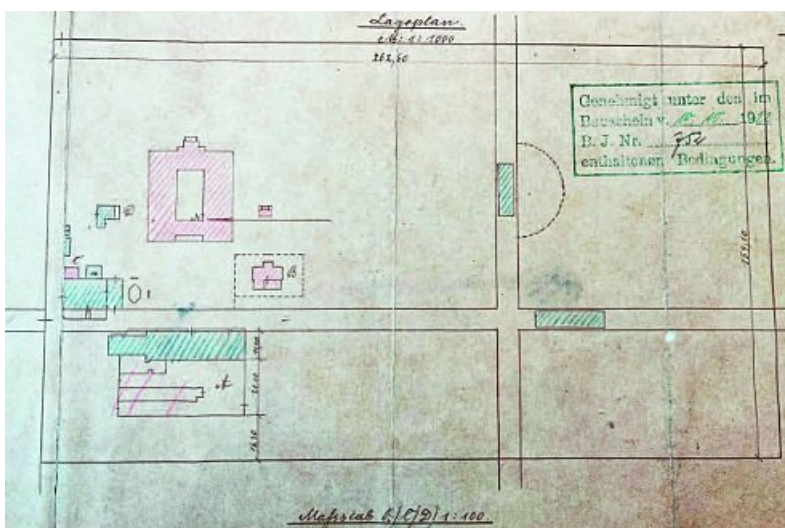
Lageplan mit Darstellung der Bestandsgebäude (blau) und der geplanten Neubauten (rot). 1922. Ausschnitt.
